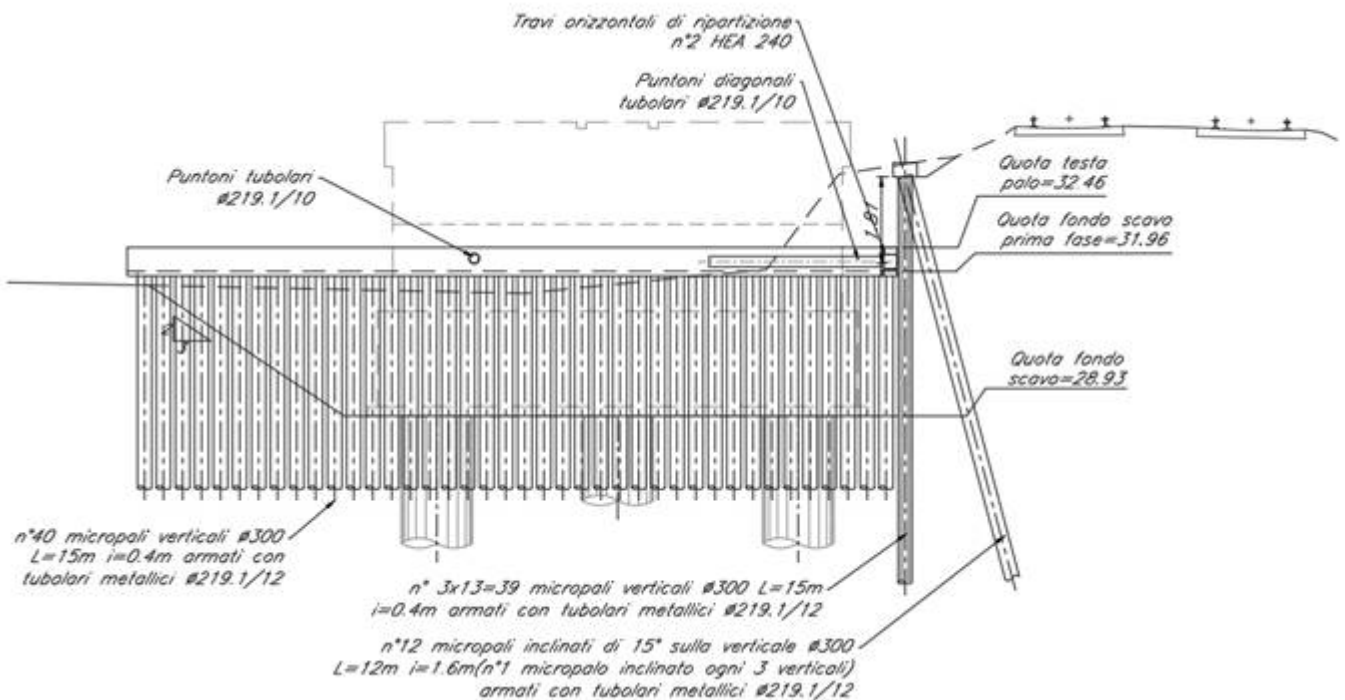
Sezione Opere Provvisionali Spalla B
